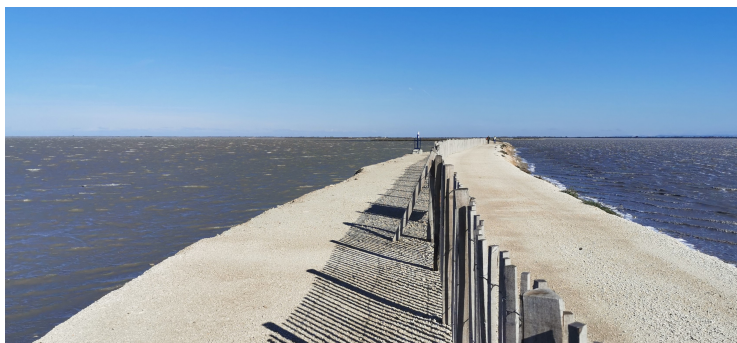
Vue générale de la plateforme Digue2020, la partie instrumentée est sur la gauche.
